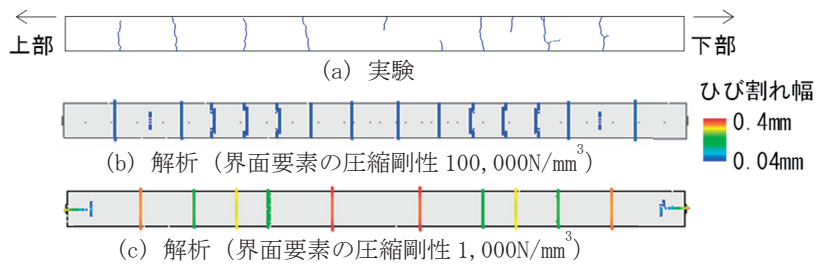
鉄筋応力度 180N/mm^2 時点のひび割れ図
